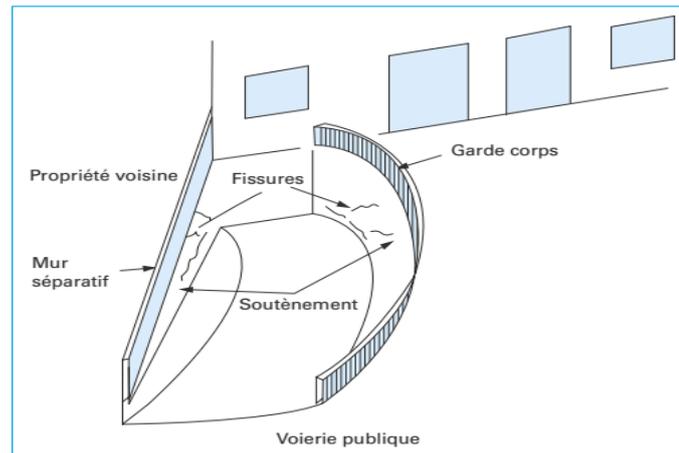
Murs latéraux de l'accès au sous-sol d'une maison individuelle.
